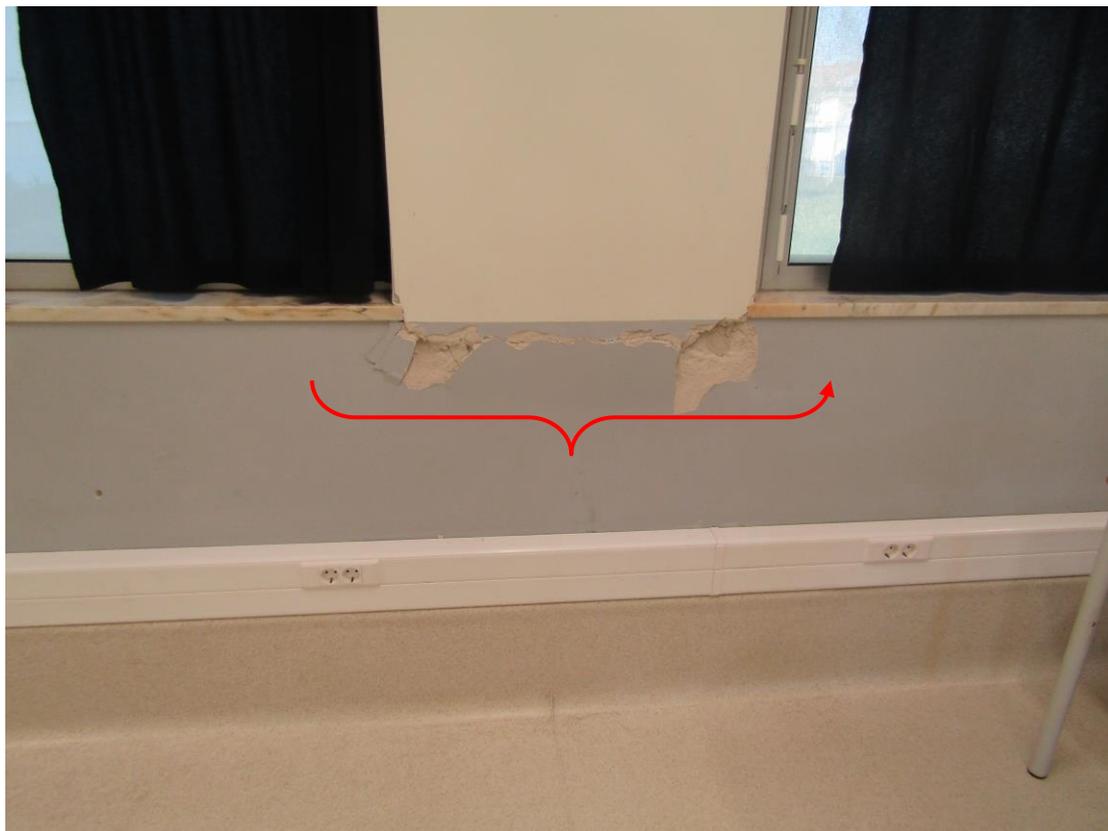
FISSURAÇÃO JUNTO AOS VÃOS EXTERIORES DE ALUMINIO
